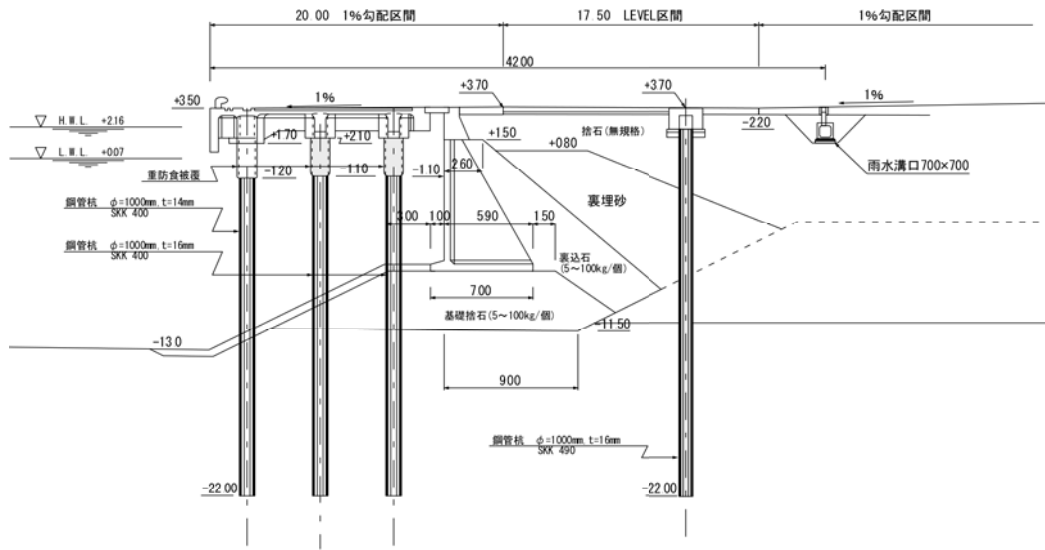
香椎パークポート地区-13m 栈橋の標準断面図
